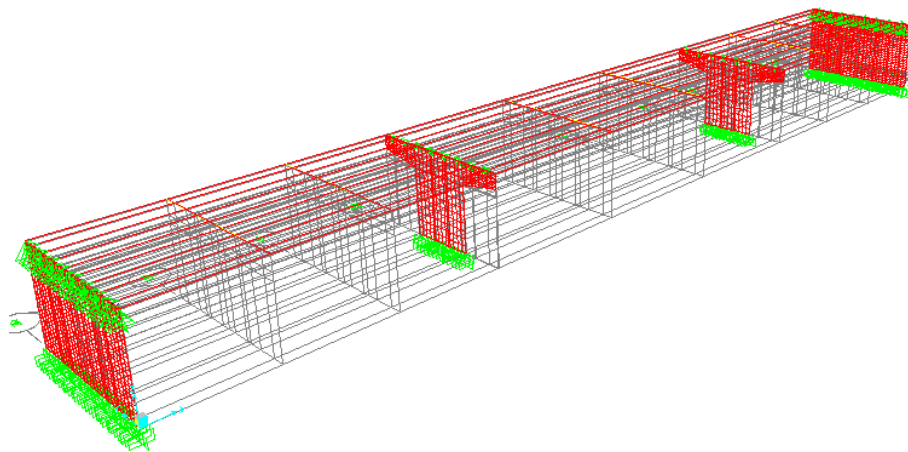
Modelo analítico del Puente Copándaro II con pilas tipo muro (elementos finitos tipo “Shell-Thick”), 3D (SAP2000).
